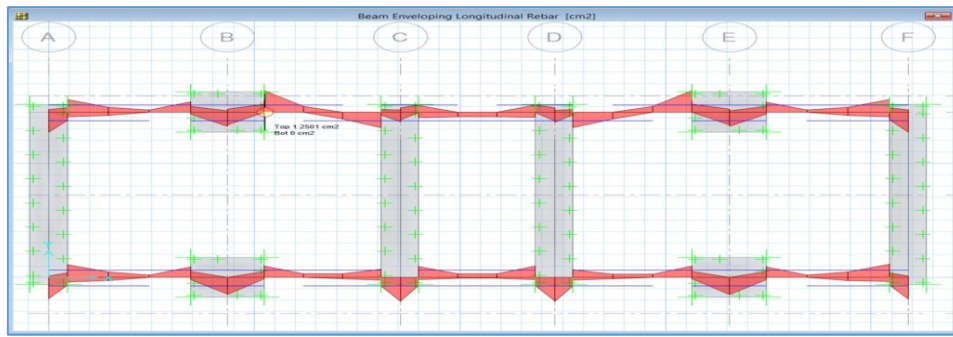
Diseño de refuerzo de varillas 1/2" dirección A y refuerzo de varillas 1/2" B
